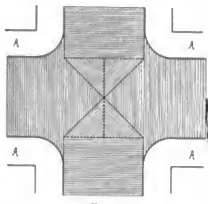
Entwässerung der Oberfläche des Betons der Holzpfasterstraßen.
